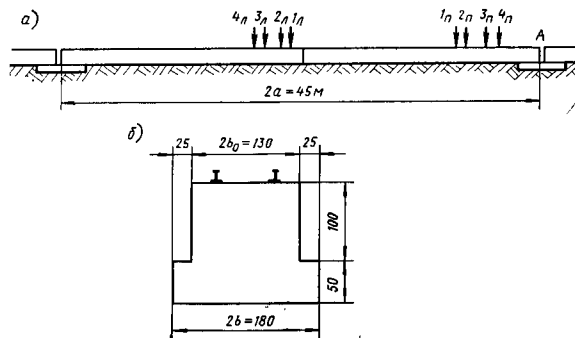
Размеры фундаментной ленты под пути мостового перегружателя
